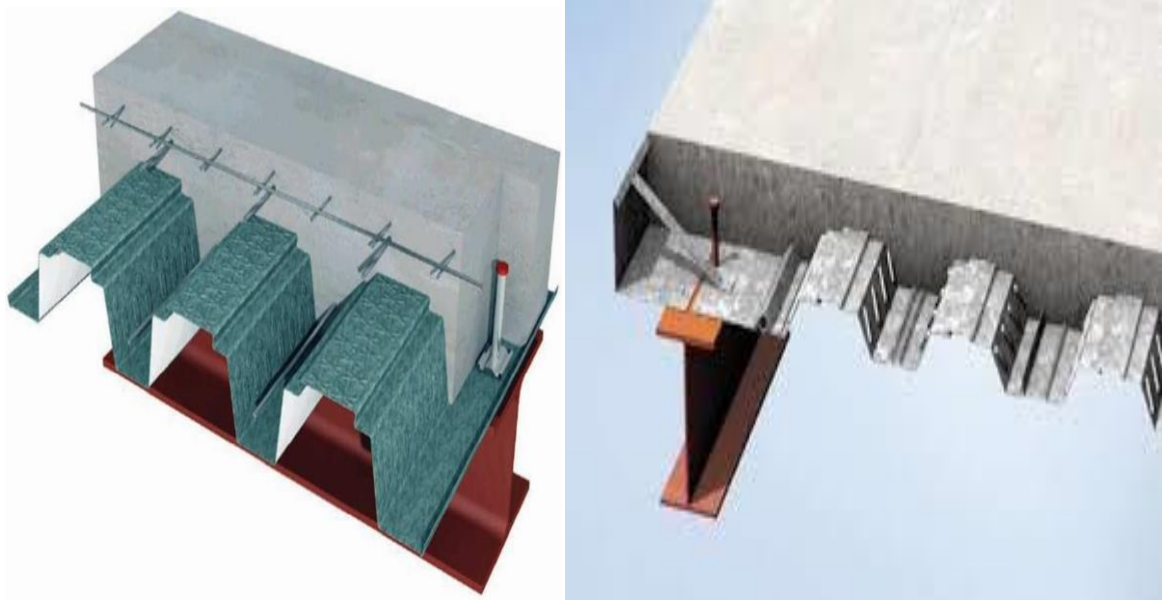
plancher collaborant mixte acier (tôle) + béton
